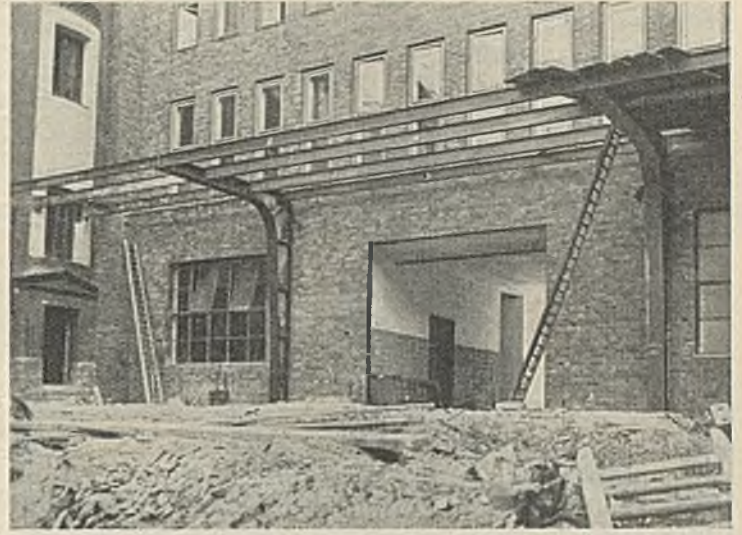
Geschweißte Stahlkonstruktion des Vordaches.
